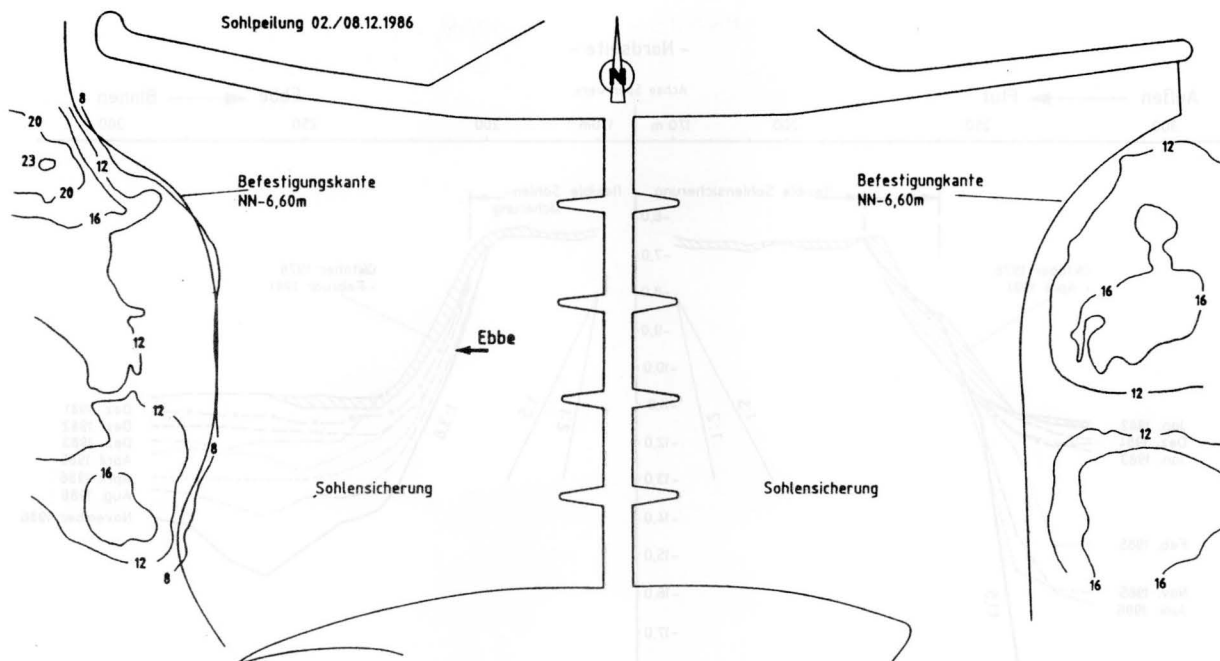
Lageplan der Kolke mit Tiefen in m unter NN. Zustand Dezember 1986
